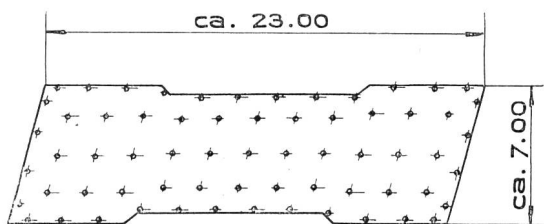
Abdichtung der Sohle einer Baugrube (Gouda, Holland).
